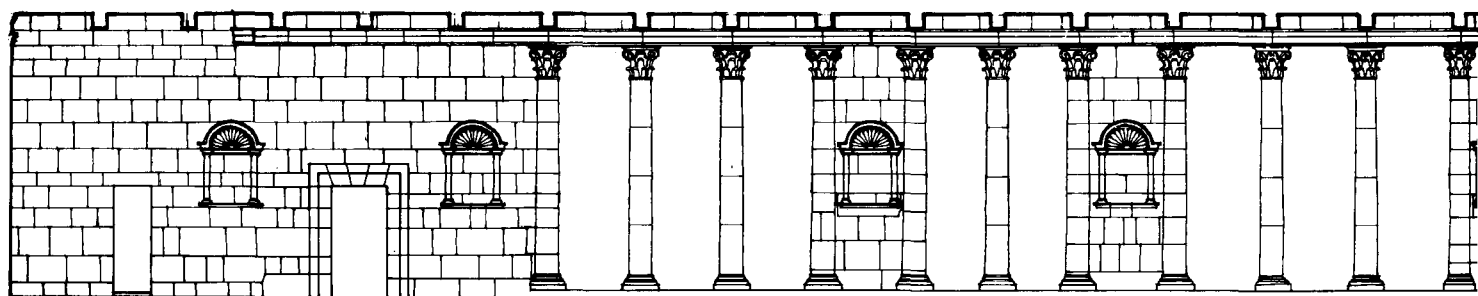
Alzado reconstruido del lado oriental del ténenos.
